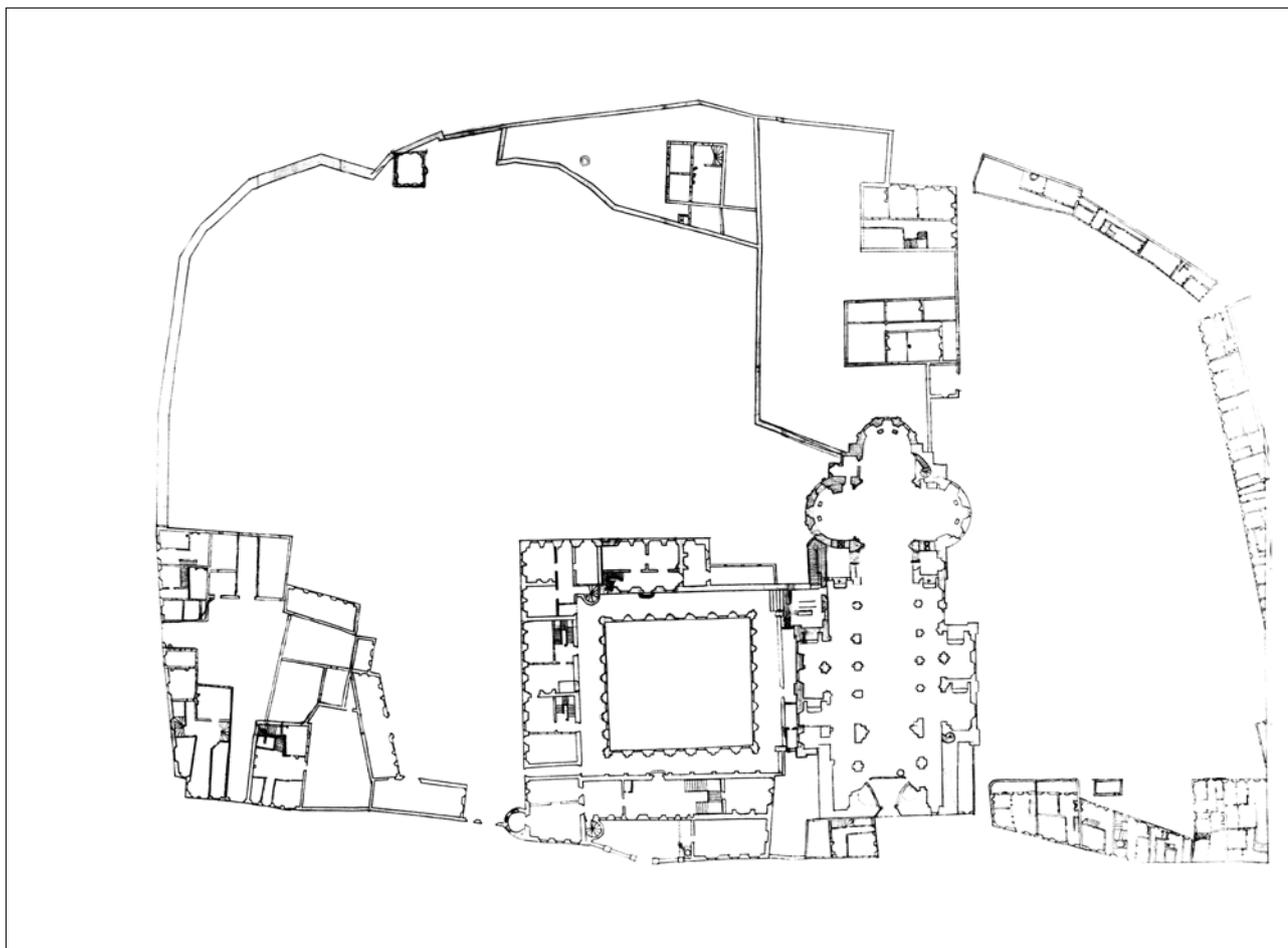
(ganz oben): Die Gebäude des Stifts St. Quirin nach einem 1802 erstellten Grundrissplan (Norden ist links).
